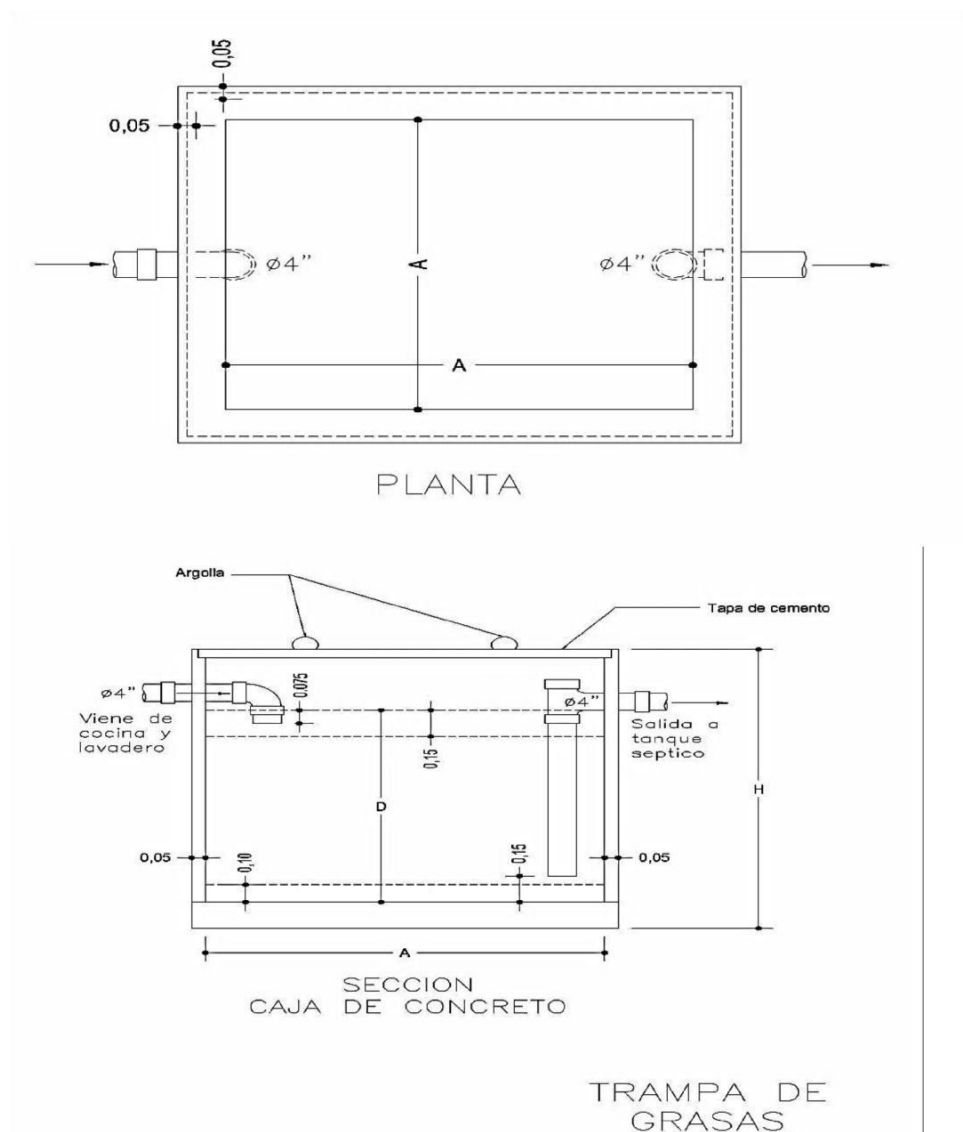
Planta y perfil de trampa grasas en vivienda rural dispersa
